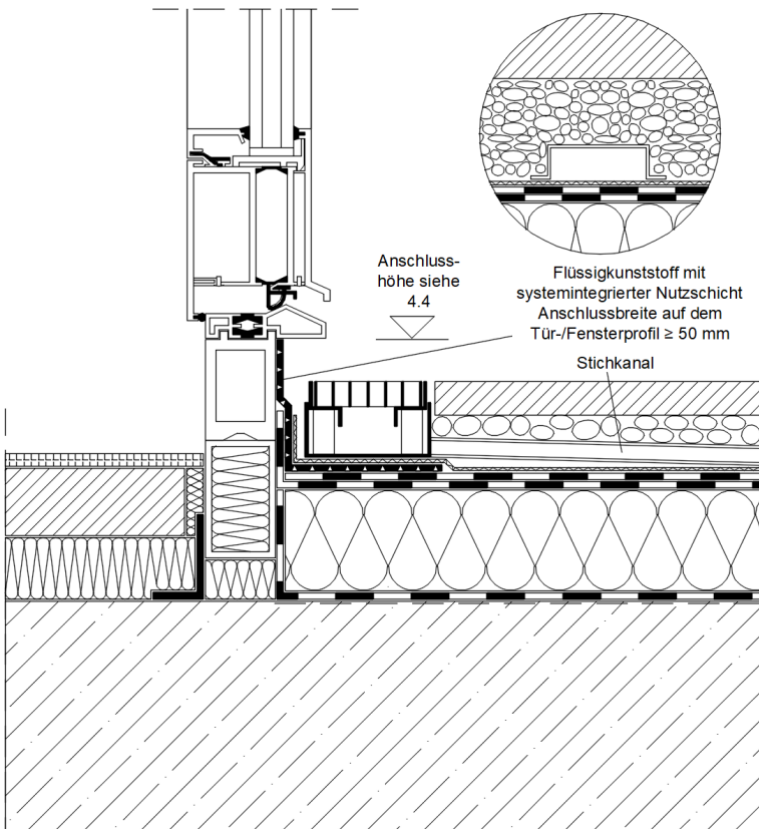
Terrassentüranschluss mit Entwässerungsrinne – Ausführung mit Kunststoffbahnen, Flüssigkunststoff und Schutzblech – Anschlusshöhe  $\geq 5$  cm (durchgehende Deckenplatte)
